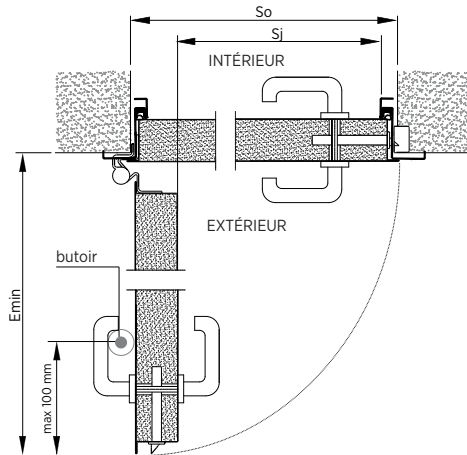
Pose devant la baie – bâti angulaire sans rupture de pont thermique – coupe horizontale
